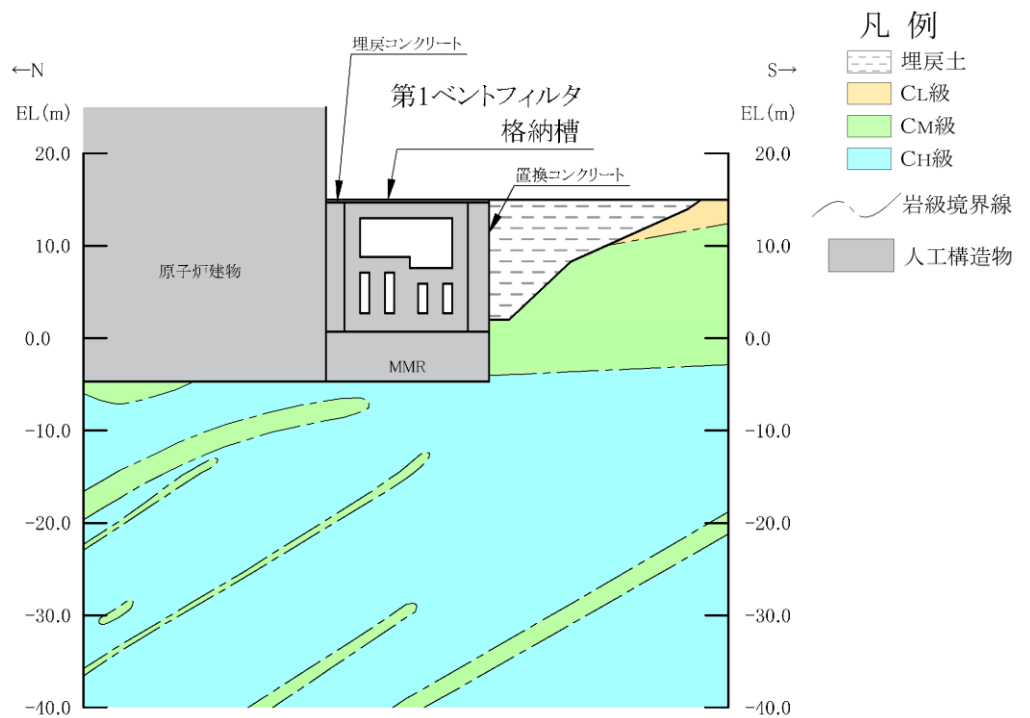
第 1 ベントフィルタ格納槽 評価対象断面図 (B-B断面位置)
